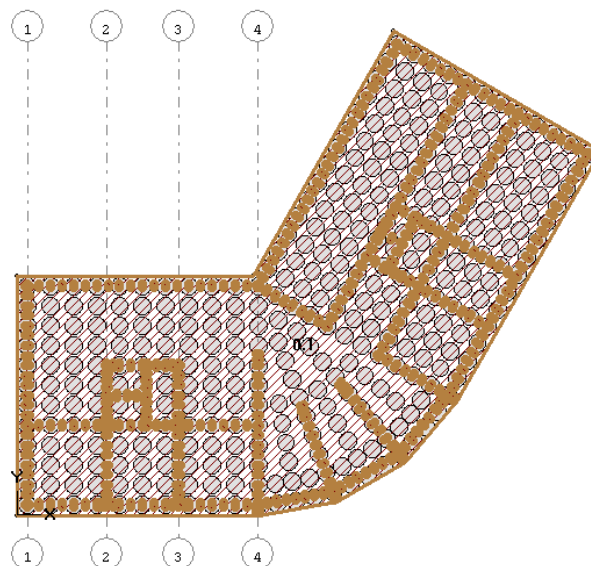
Фундаментная плита №1_1 на свайном поле с нагрузками
